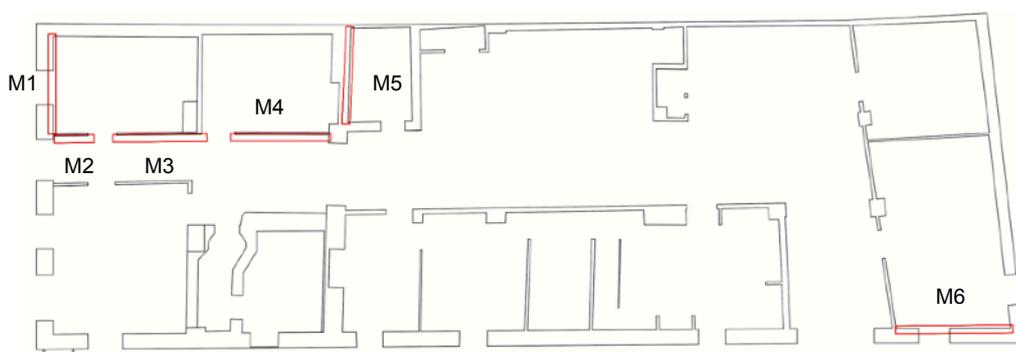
Planta referencial de la puesta de mallado virtual en muros de ladrillo y mortero de cal.
